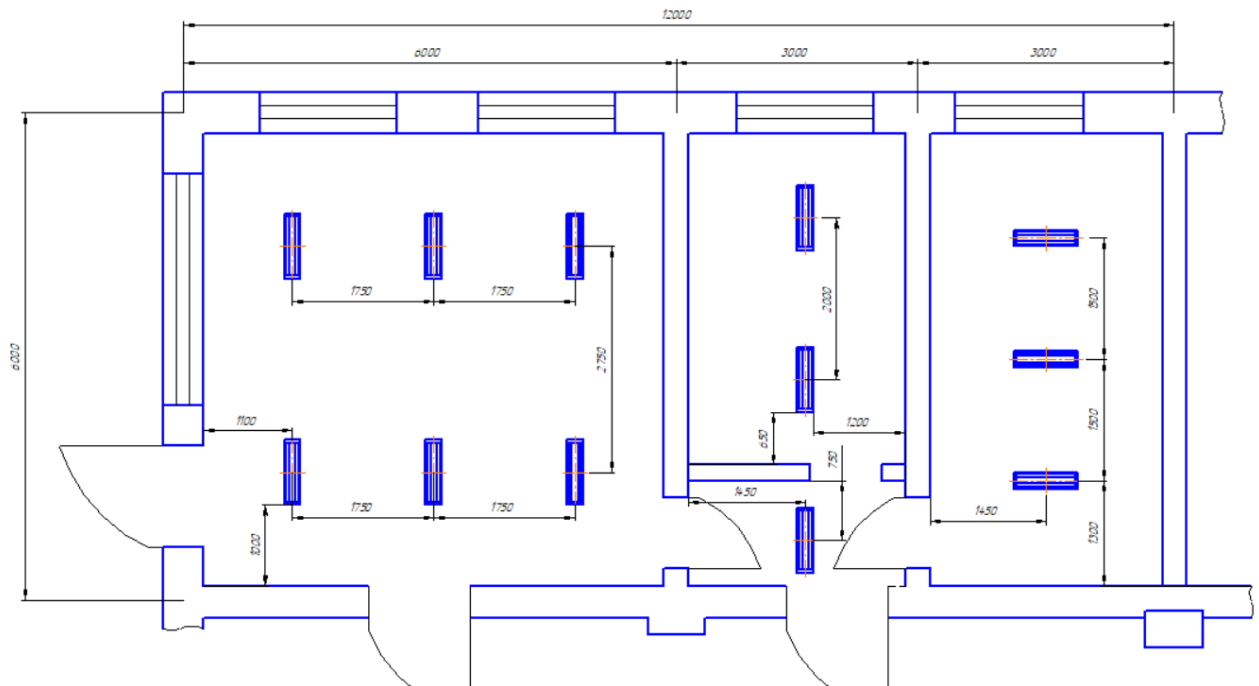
Система освітлення дільниці з ремонту обладнання ферм
